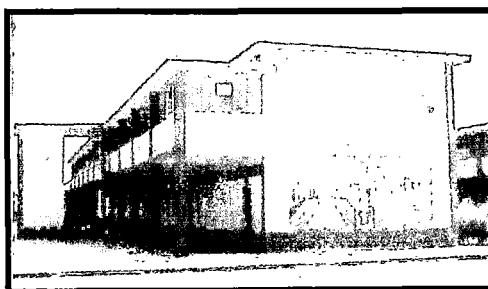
GUE Maria Parado de Bellido, estructuración tipo I
